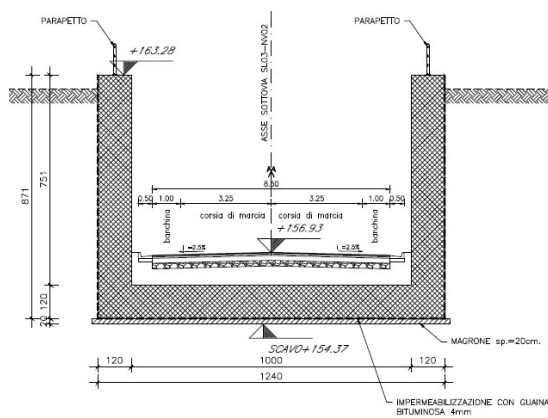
Sezione trasversale muri ad U sottovia SL03
